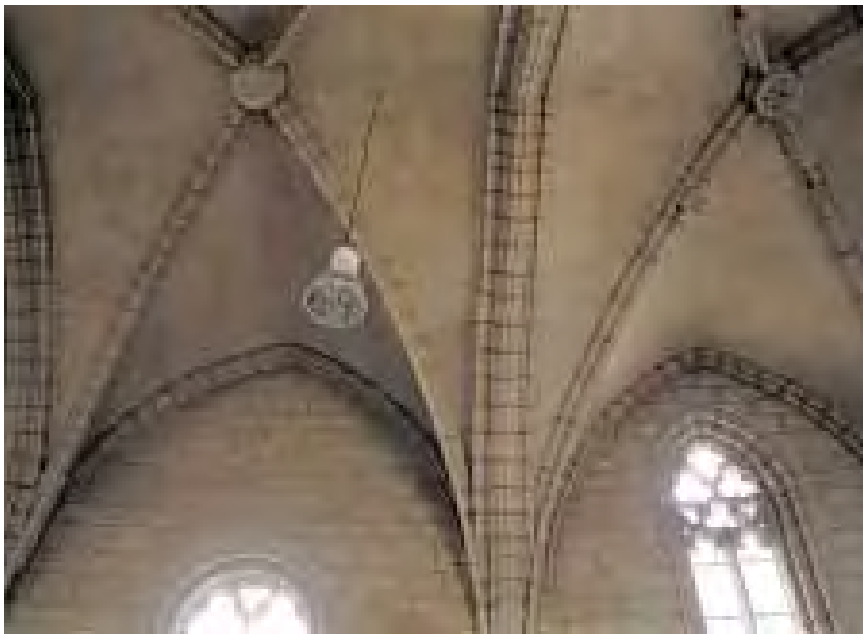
Arranque de las bóvedas de la nave central sobre la pilastra norte entre los tramos cuarto y quinto. Se aprecia la diferente alineación de los dos paños de muro a un lado y otro de la pilastra provocada por el giro de ésta hacia el exterior –norte– debido al apoyo de su contrafuerte sobre el arco perpiñón de la nave central
